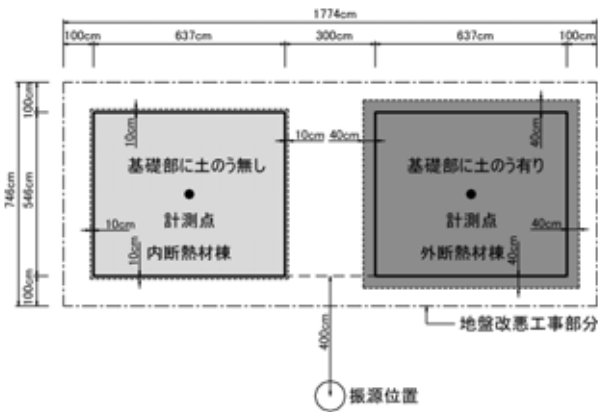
基礎部に土のう積層体を配置した場合と配置しない場合の2棟の平面図
